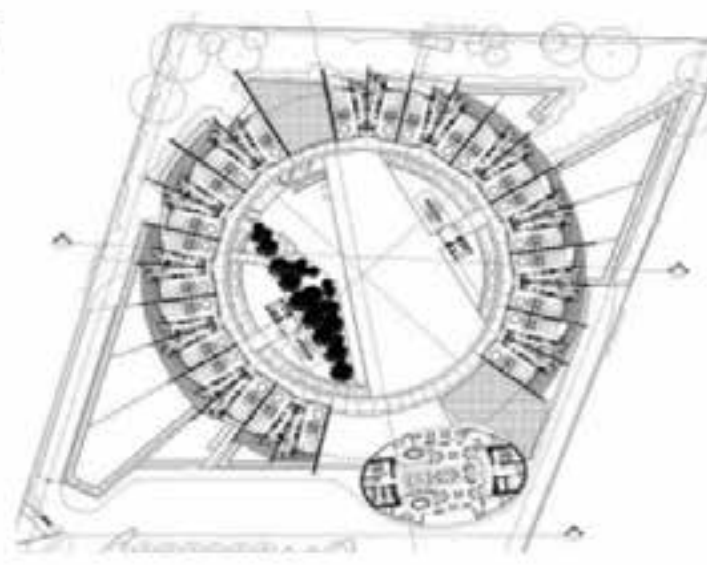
Planta suites de hotel habita en Monterrey. Foto int
